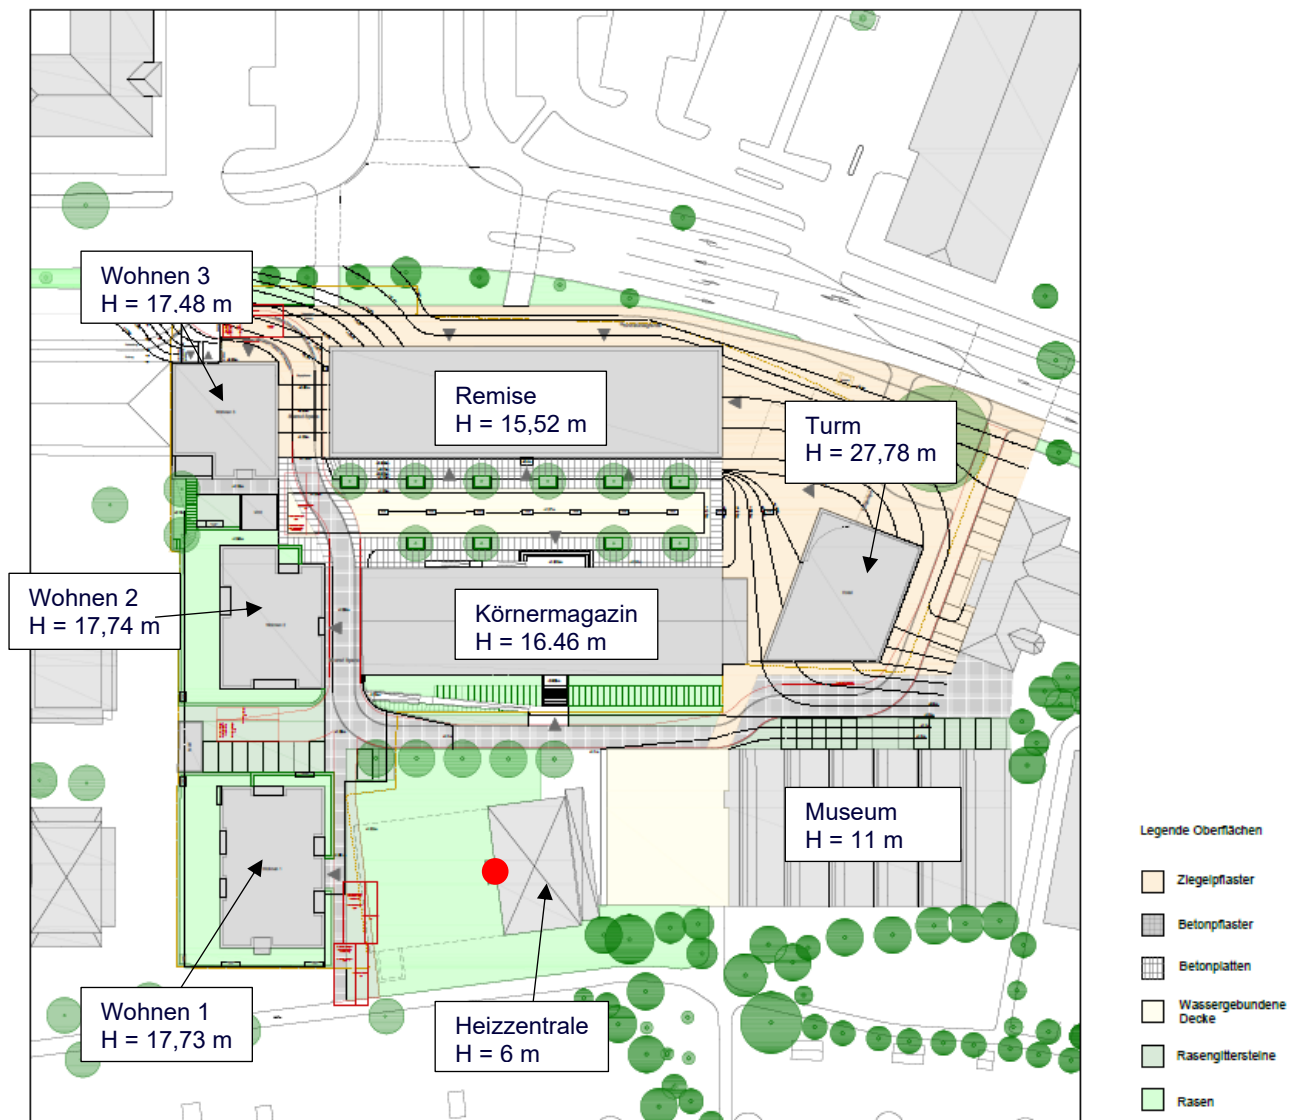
Lageplan des Neubaus/Umbau Areal Körnermagazin, in Rot der Schornsteinstandort
